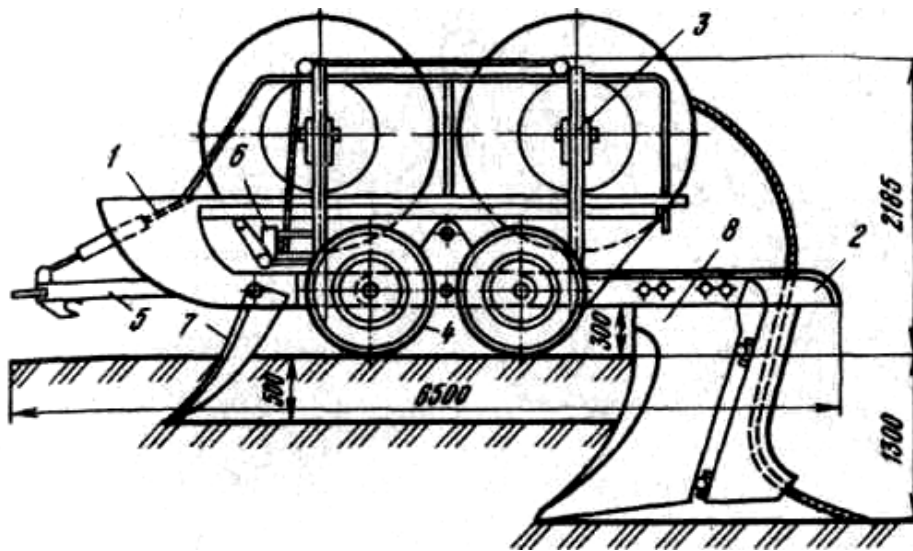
Кабелеукладчик на колесном ходу: 1 — корпус; 2 — основная рама; 3 — рама для барабанов; 4 — колеса; 5 — дышло; 6 — лебедка; 7 — пропорочный нож; 8 — главный нож.
